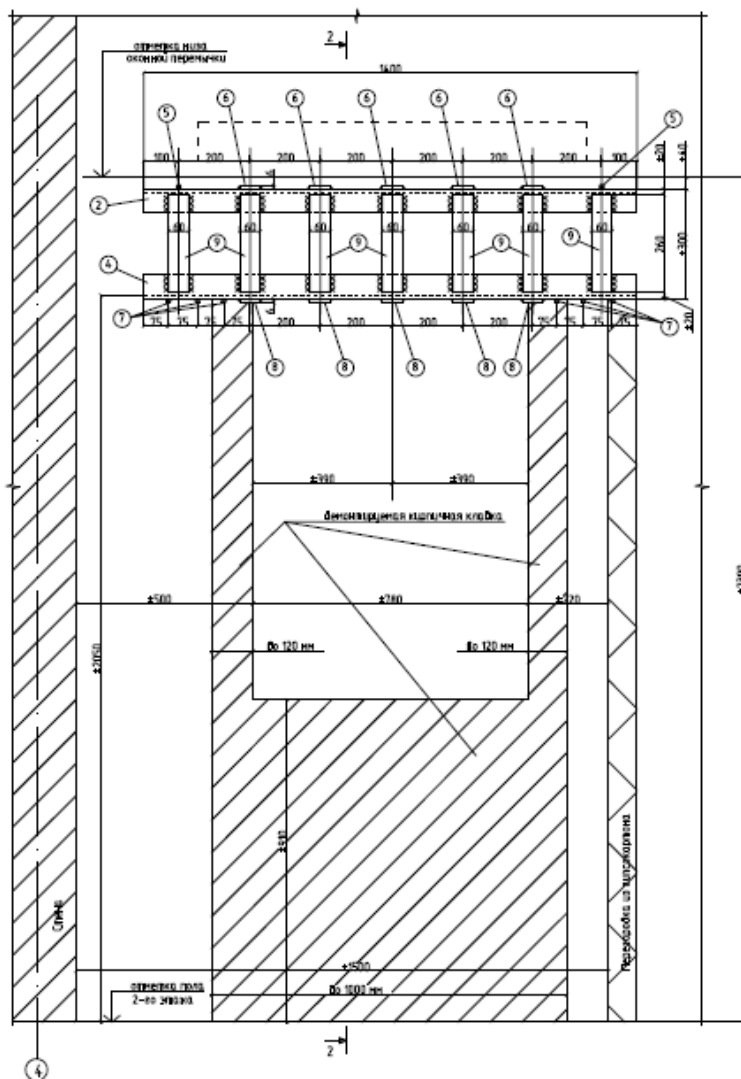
Установка решетчатой перемычки под существующими сборными
